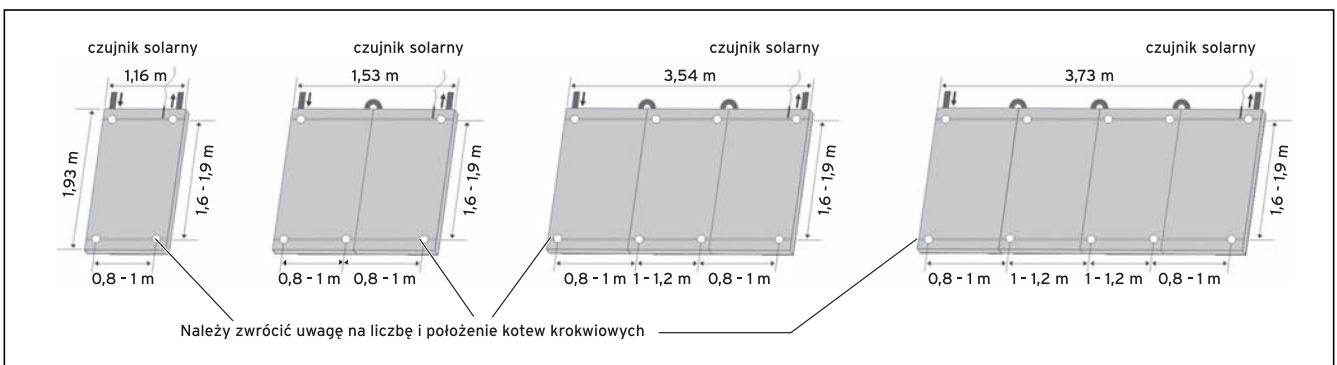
Wymiary kotew krokwiowych do różnych typów pokryć dachowych:
